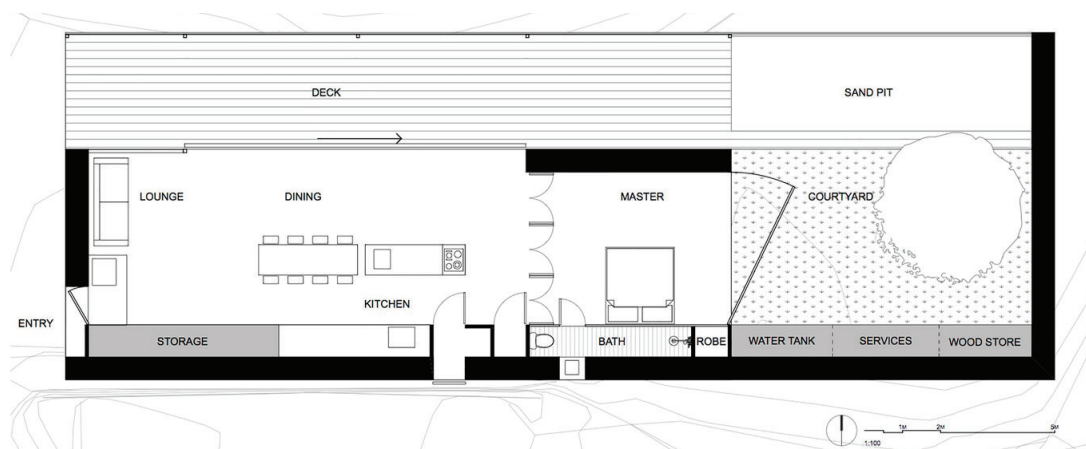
Pianta piano terra; Fonte: <http://archdaily.com/>;
